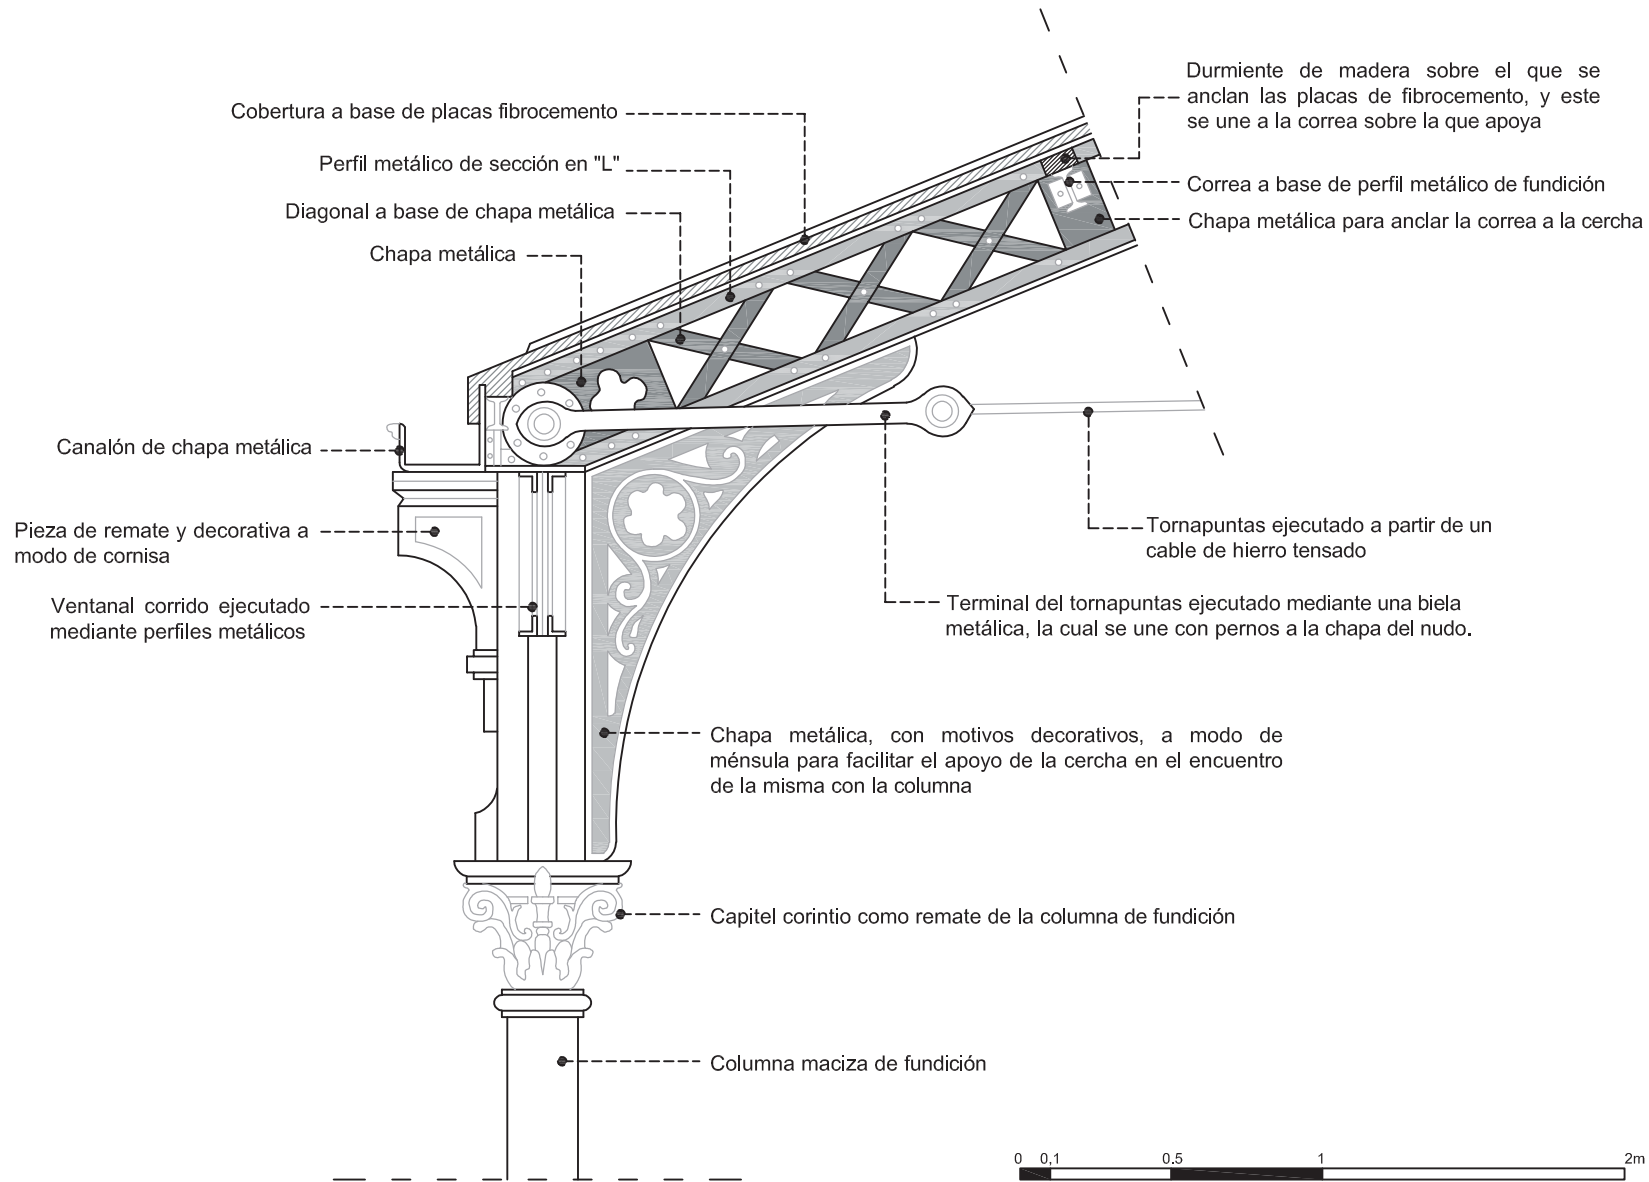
Detalle constructivo encuentro cercha-columna de fundición
